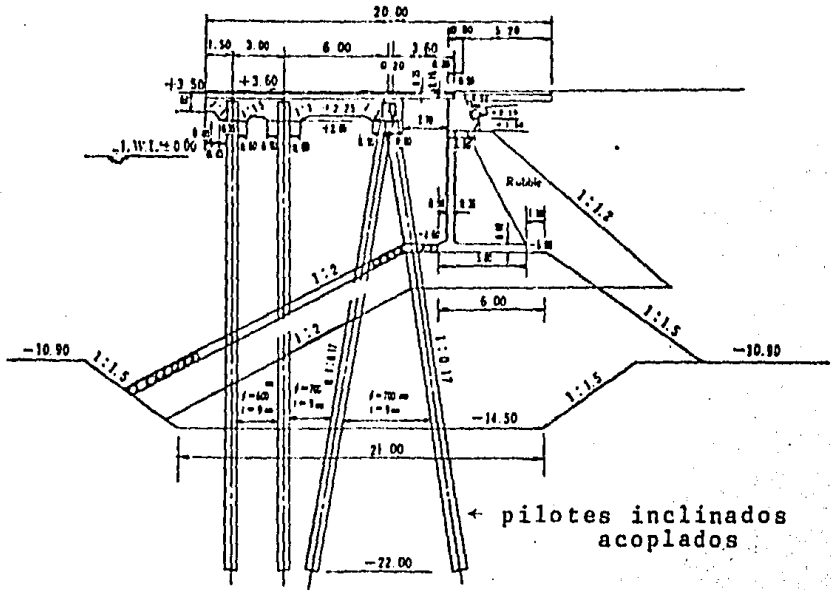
Sección transversal de un muelle cuya cimentación está formada a base de baterías de pilotes verticales e inclinados acoplados.
